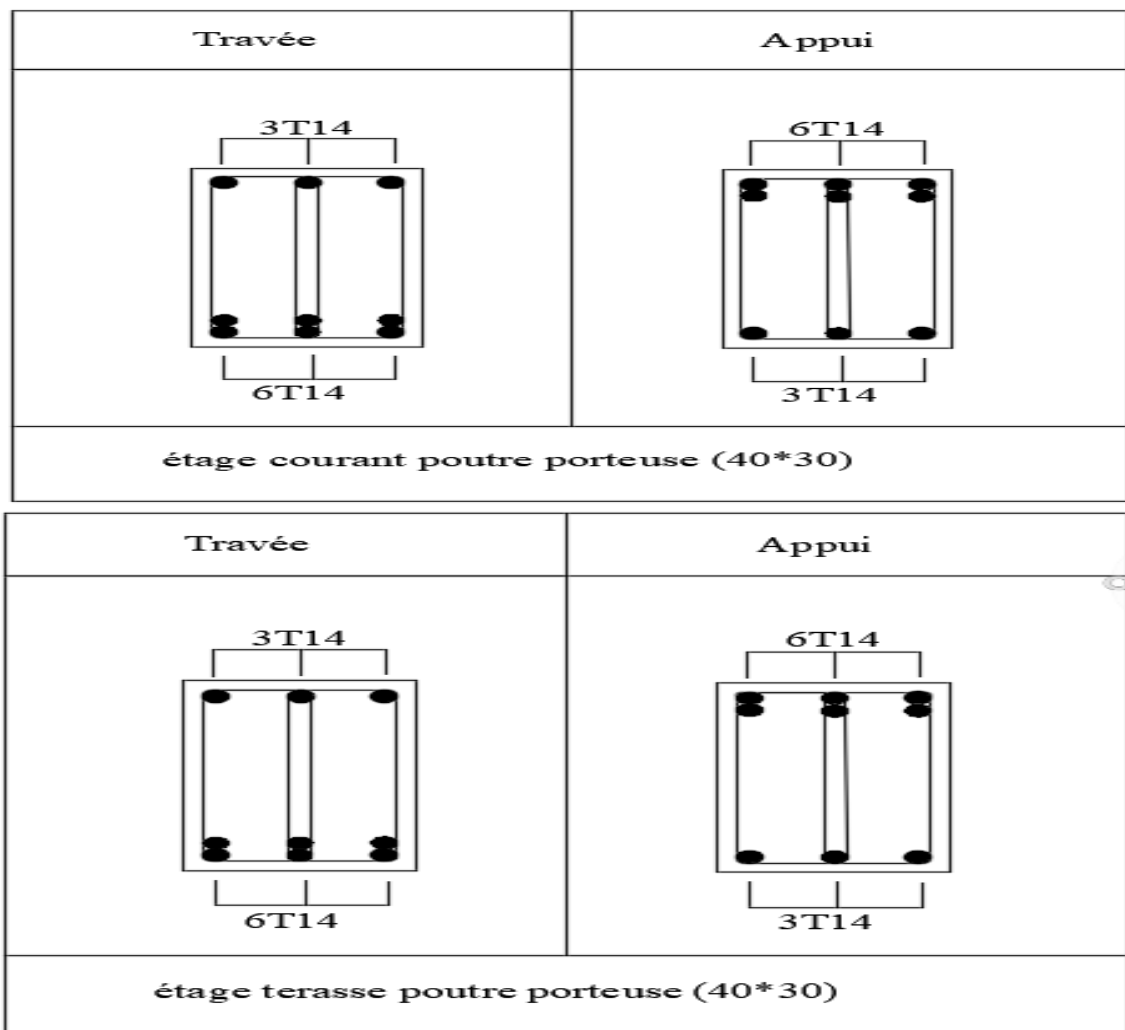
Schéma de ferrailage des poutres porteuses.
